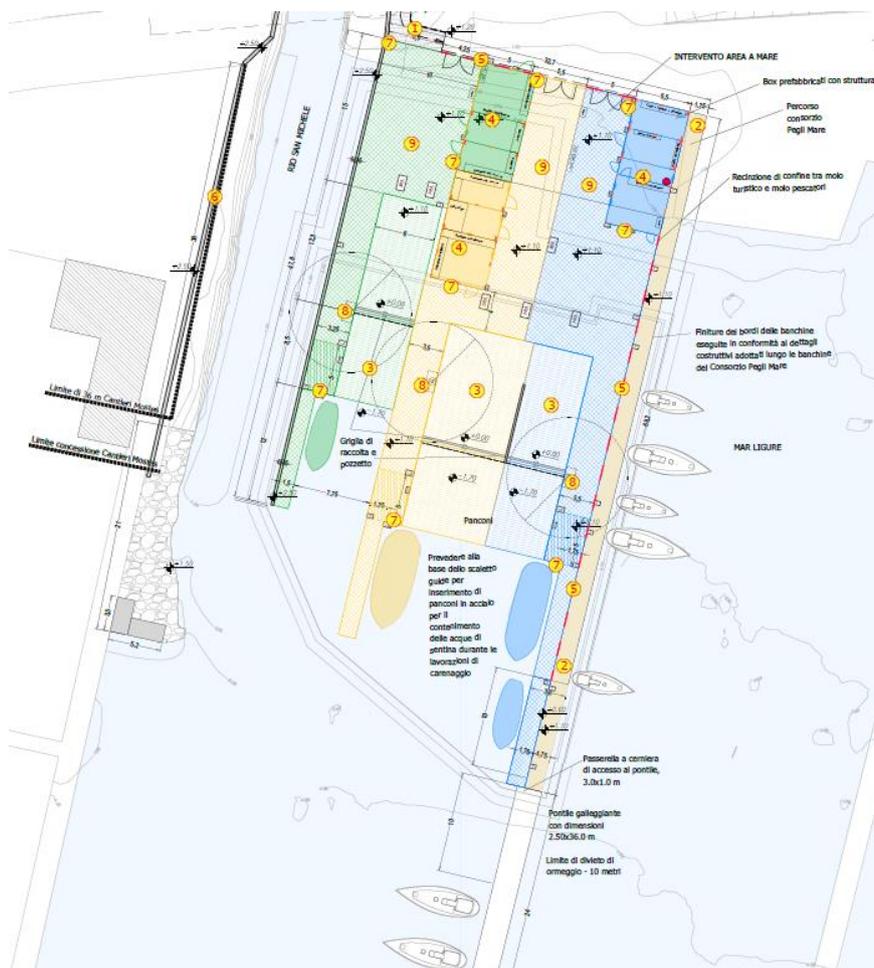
Planimetria di progetto area Pescatori - Dettagli
